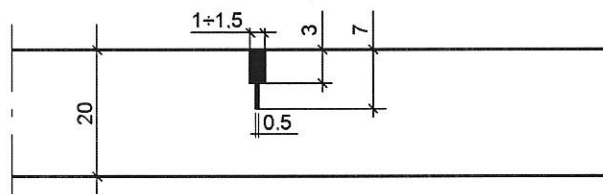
Przykłady konstrukcji szczelin w podbudowie z betonu cementowego
